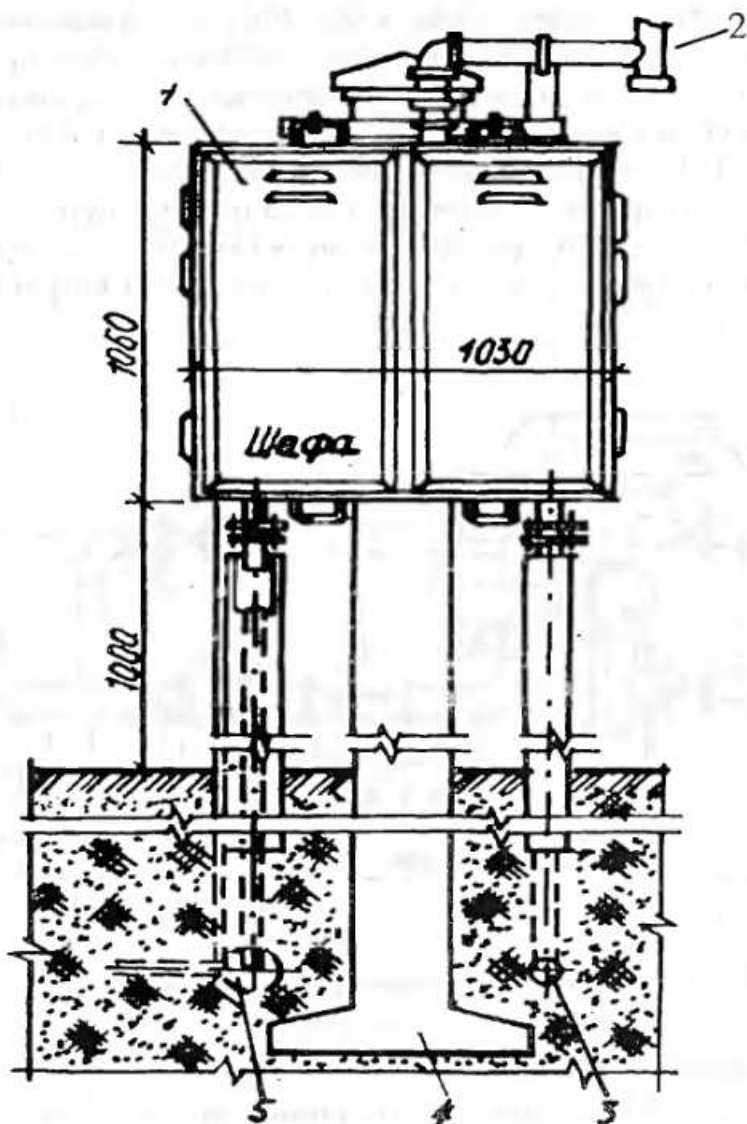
Газорегуляторний пункт шафового типу: 1 - металева шафа; 2 - продувальна свічка; 3 - вхід газу; 4 - залізобетонна опора; 5 - вихід газу
